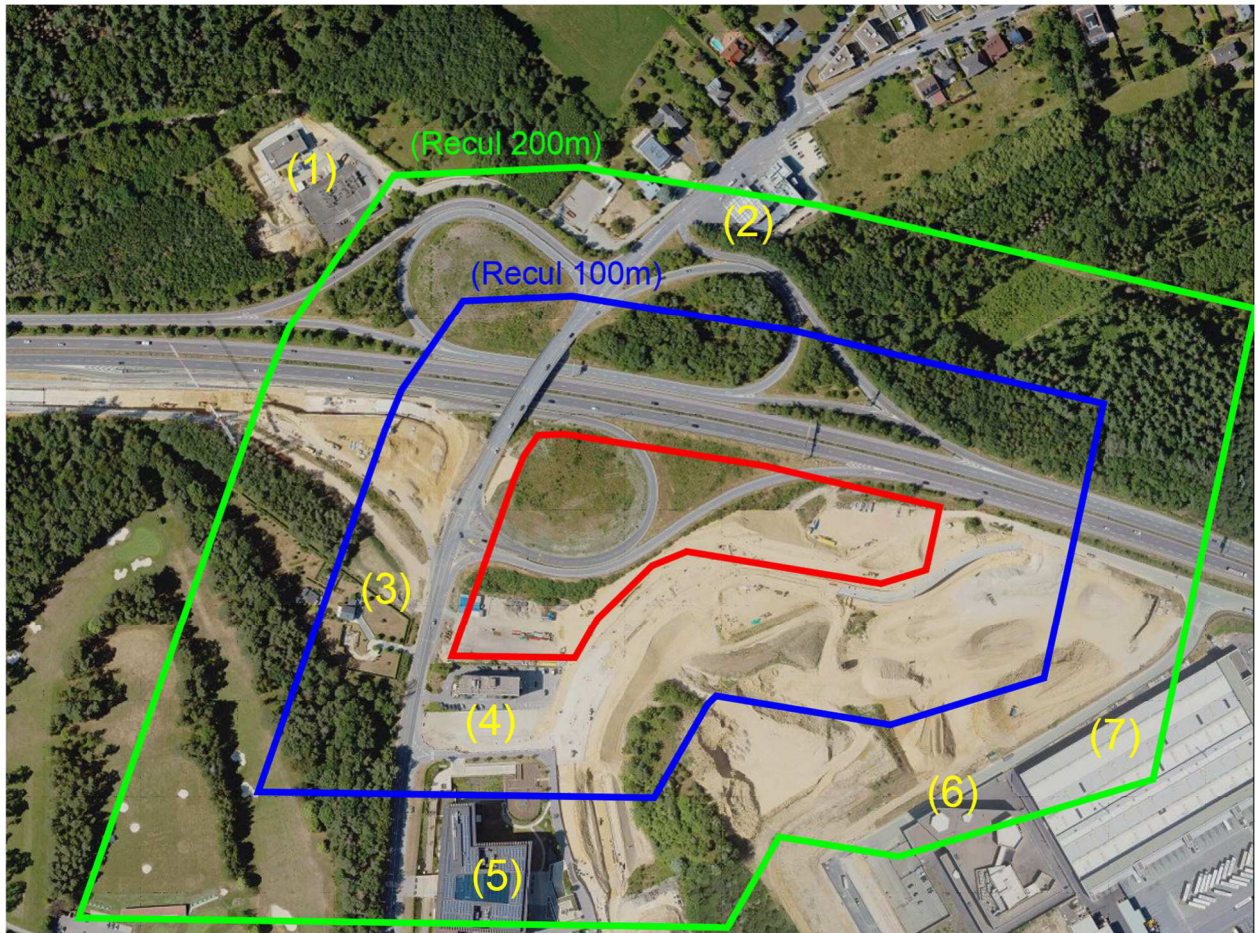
Situation du projet et des zones de recul (fond de plan : geoportail.lu- orthophoto 2023)
